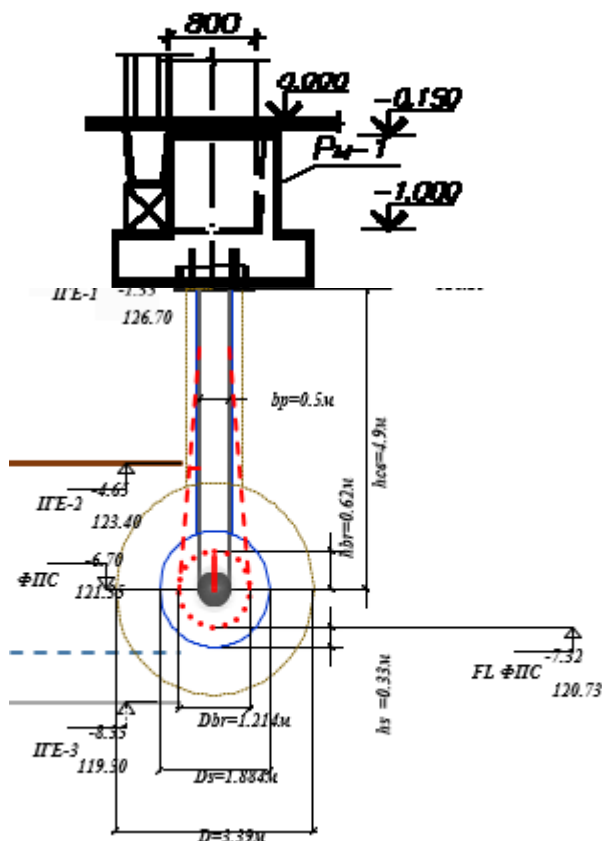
Монолітний ростверк фундаменту з НППС -4.9-50-1.5
